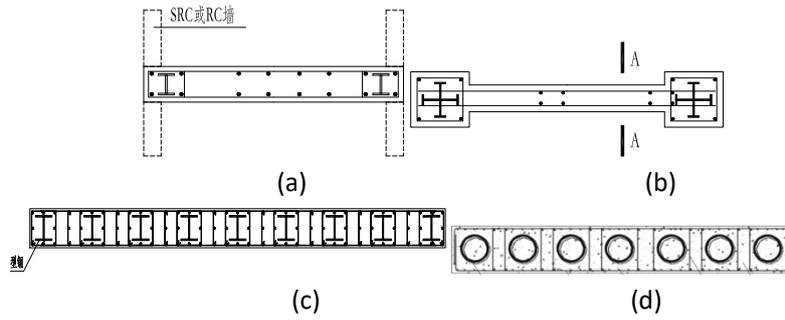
钢-混凝土组合剪力墙截面形式示意图
